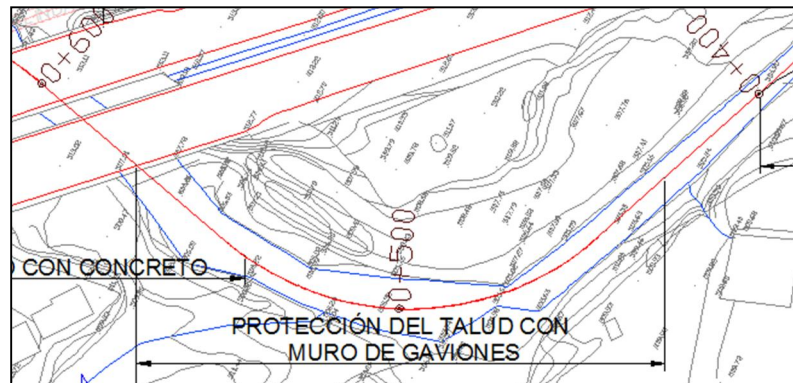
Ubicación en planta del muro de gaviones. Nota. Elaboración de los autores.
